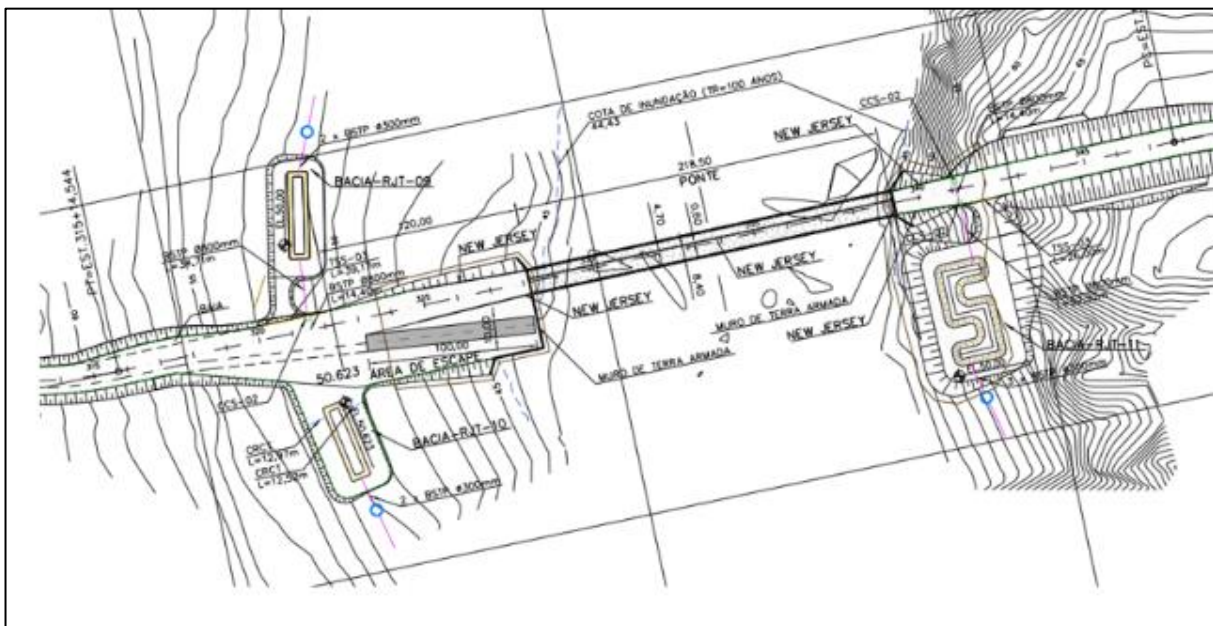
Planta ilustrativa da travessia do Igarapé Jamari.
